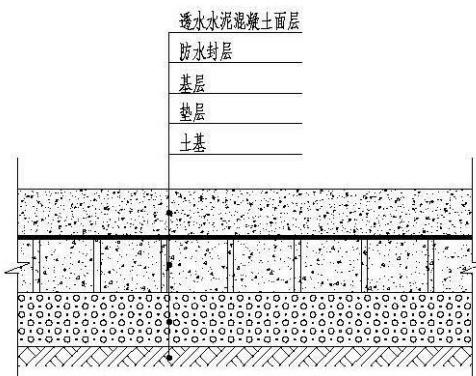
半透式水泥混凝土路面结构示意图 图 5.2.2-2 半透式水泥混凝土路面边缘排水设施示意图
